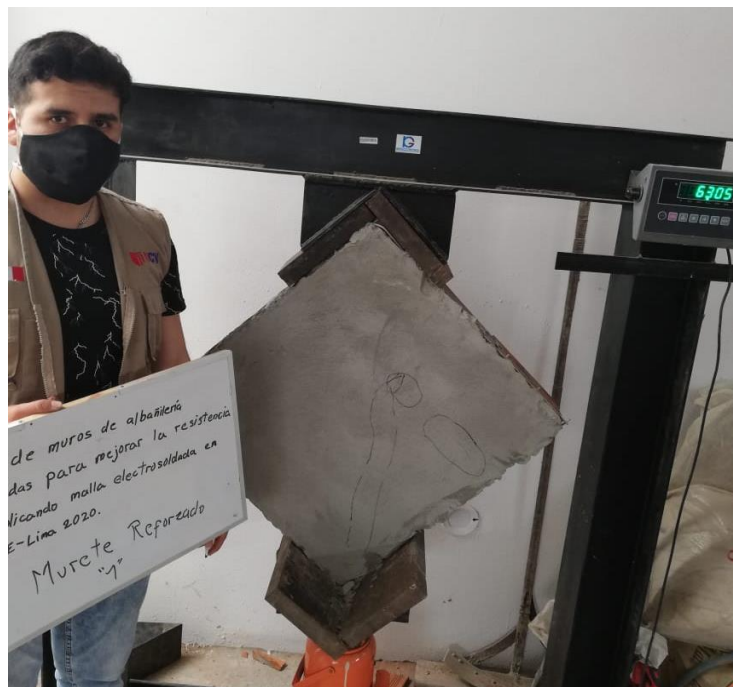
Falla de corte diagonal en murete reforzado presentado en fisura de 0.7mm.
